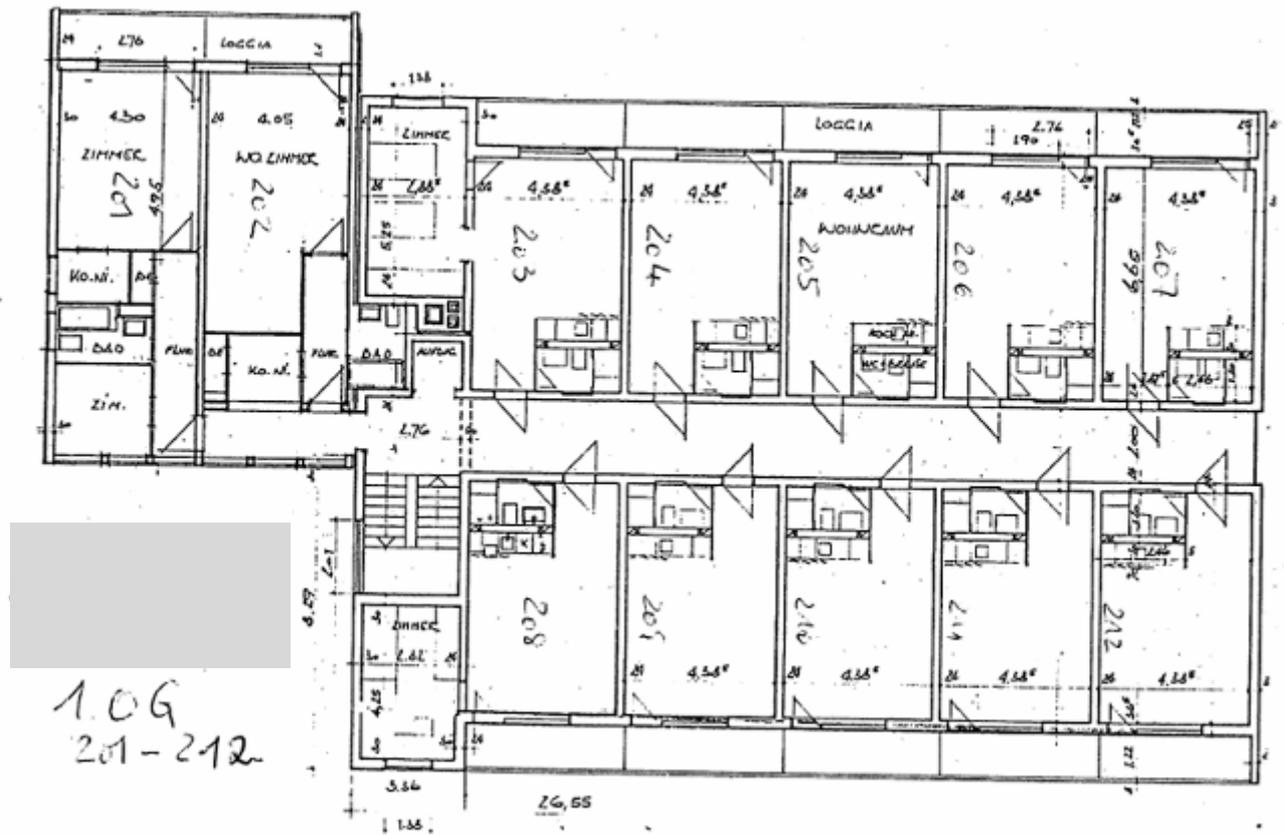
Grundriss Obergeschoss 1 - 3; Quelle: Schuldnerseite
